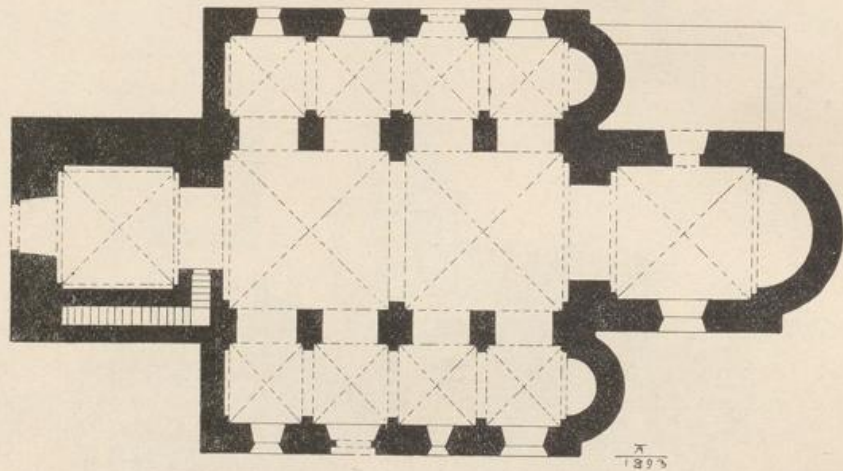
Herkenrath. Grundriss der katholischen Pfarrkirche vor dem Umbau.
